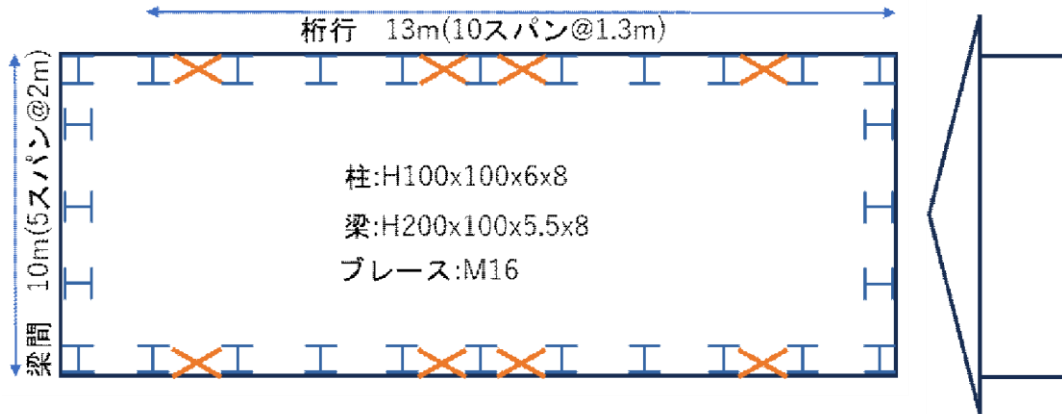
鉄骨造倉庫の平面図 (5.7-11)
